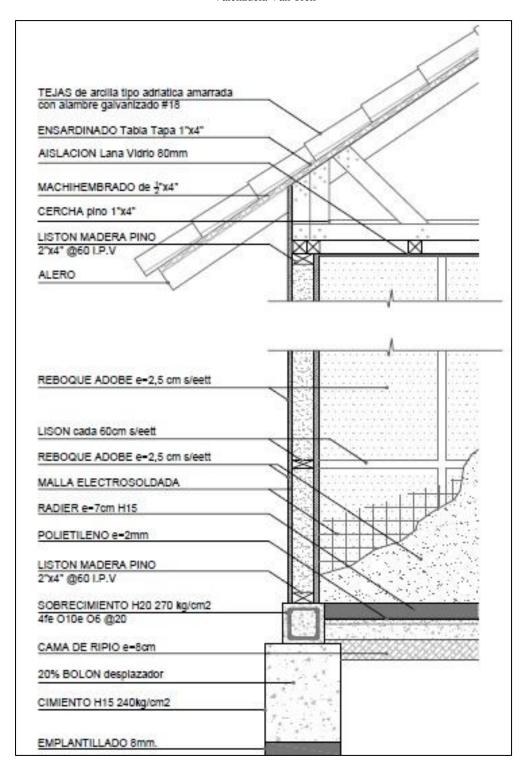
proceso de construcción vivienda nueva. Fuente: José Silva, habitante de Zúñiga
